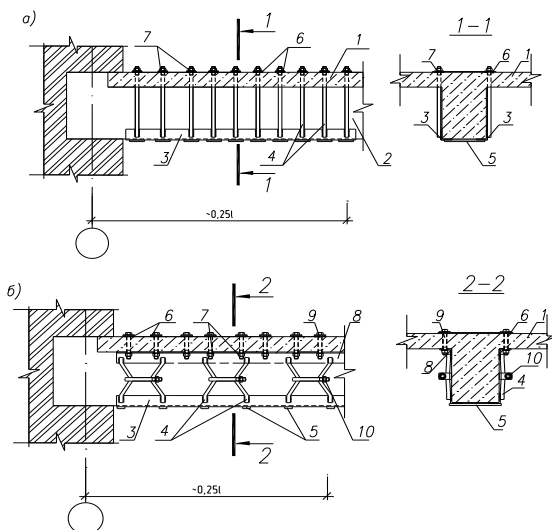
Схема усиления наклонных сечений железобетонных балок:
